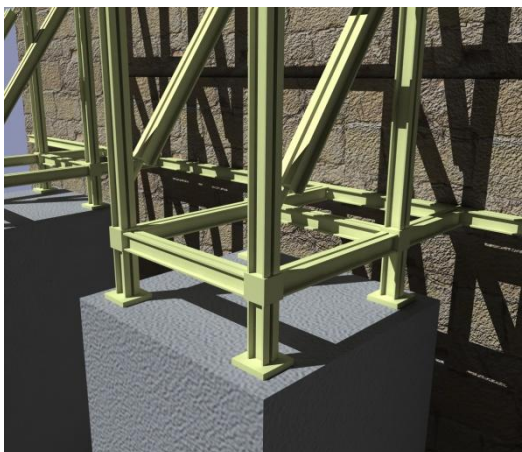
Representación del anclaje de la estructura con los dados de hormigón previamente ejecutados.
